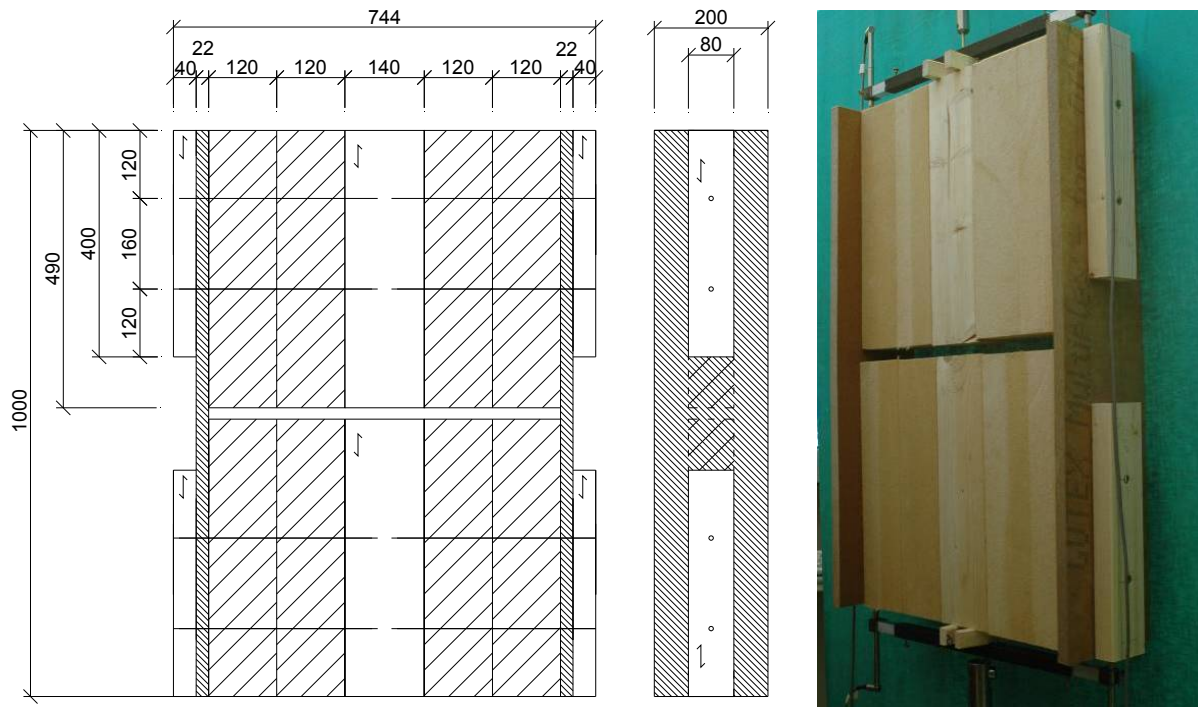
Zugscherkörper einer Holz-HFDP-Verbindung in einem zweilagigen Aufsparrendämmsystem (Dämmschicht 2 x 120 mm, Maße in mm)
